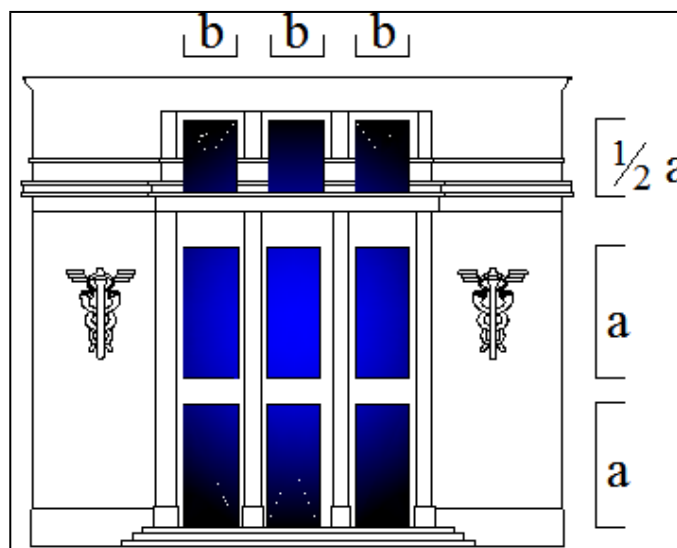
Les dimensions d'ouverture de la façade du palais consulaire
